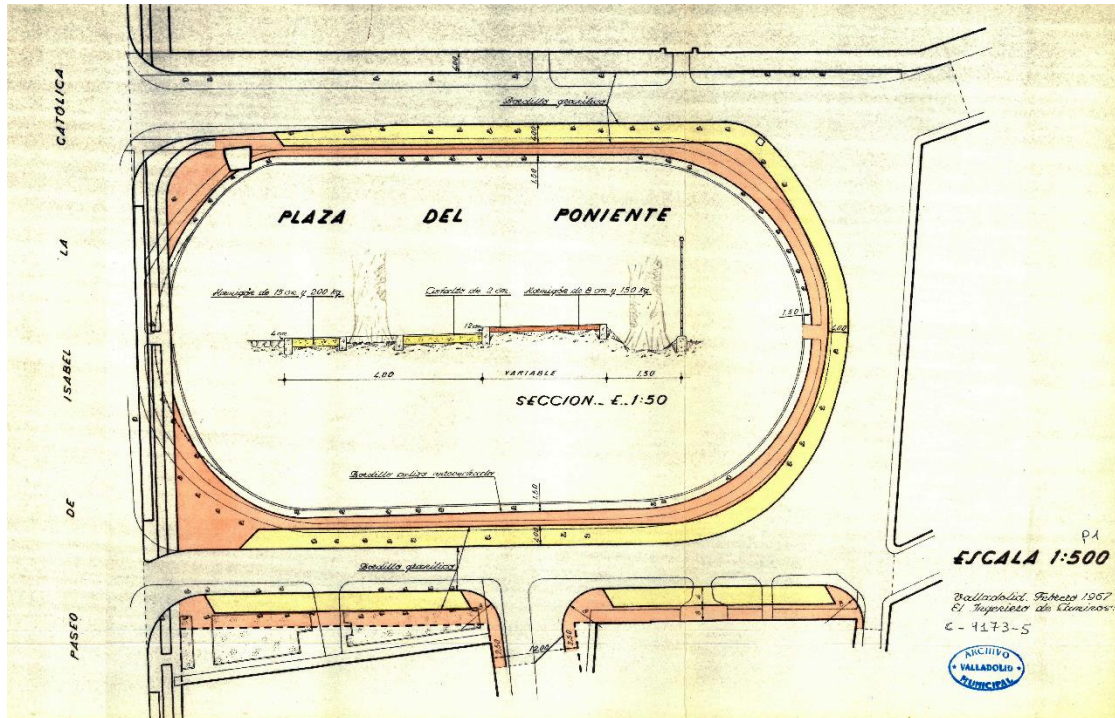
Proyecto de aparcamientos, aceras y ensanche de calzada y pavimento de aglomerado asfáltico en la Plaza de Poniente (AMVA, Expediente C-9173-5, 1966)
